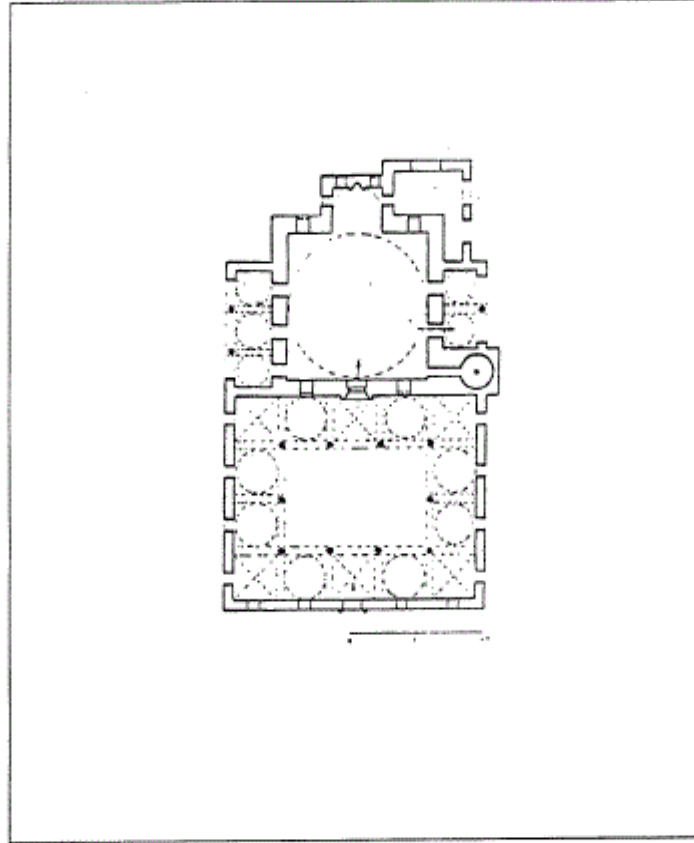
مسقط أفقي لمسجد لاله لي في استانبول (عن : جودوين) .
